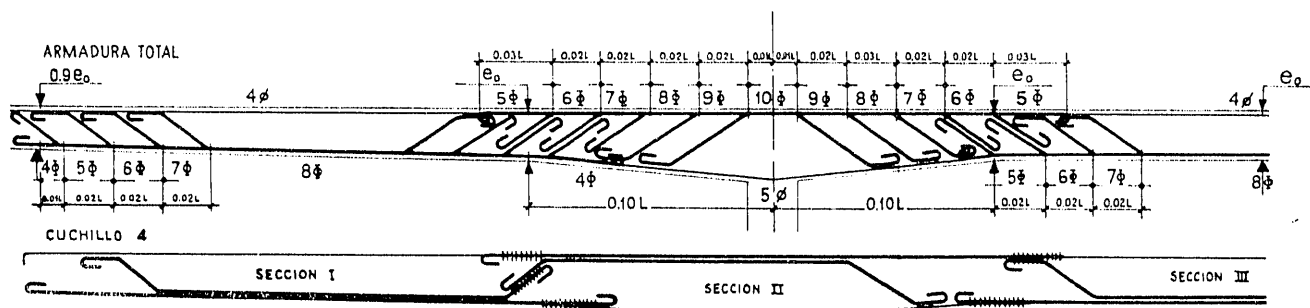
Armadura principal de una viga y detalle de un cuchillo.
